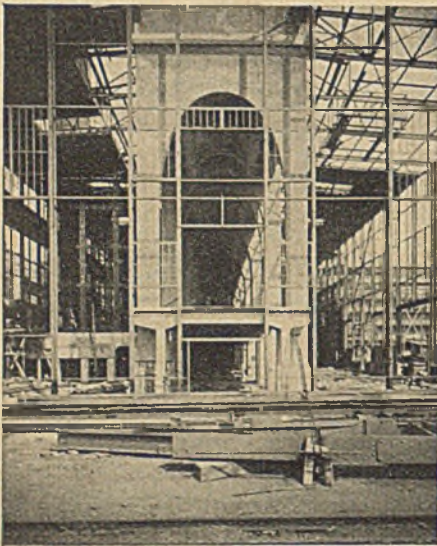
Großkraftwerk Golpa-Zschornowitz. Erweiterungsanlagen 1926. Giebelansicht des Kesselhauses mit Eisenbeton-Kohlenbunker.
